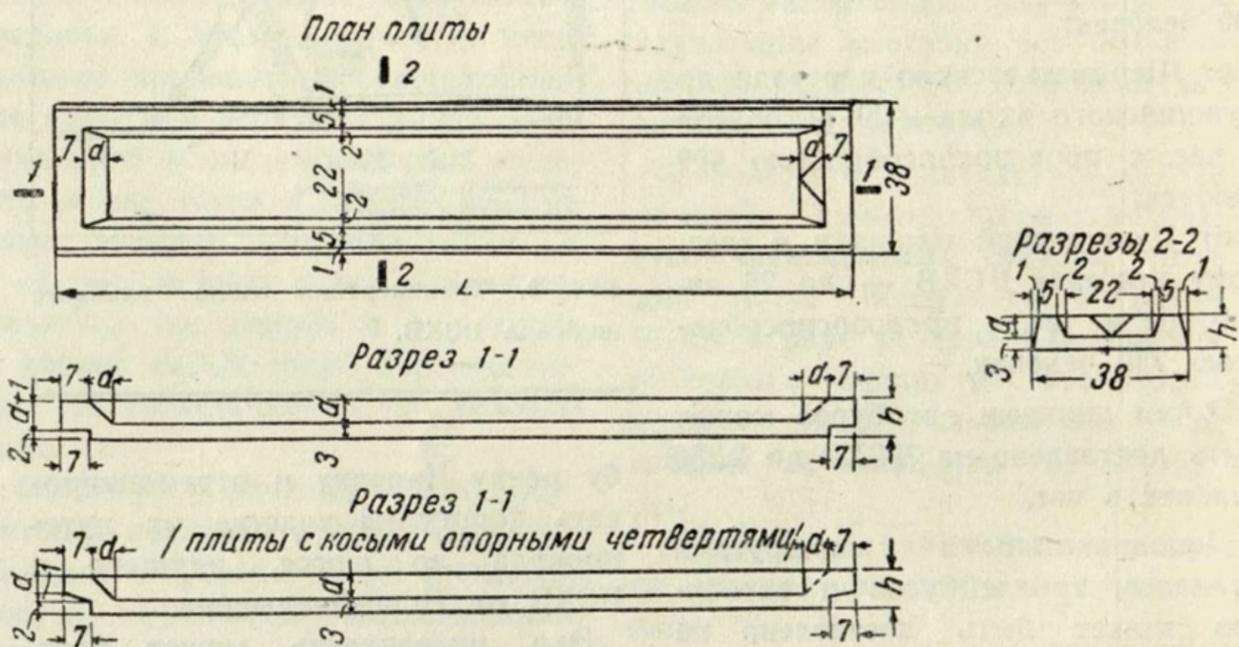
Плиты междуэтажных перекрытий марки «ПМТ». Внешним отличительным признаком этих плит от плит «ПМ» служит треугольный выступ на опорной диафрагме.
